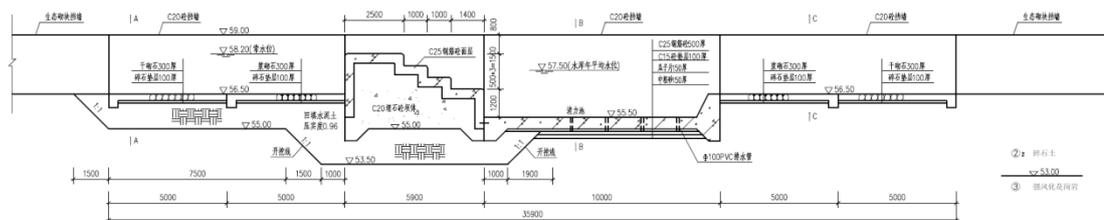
百花河湿地进口挡坎剖面图
